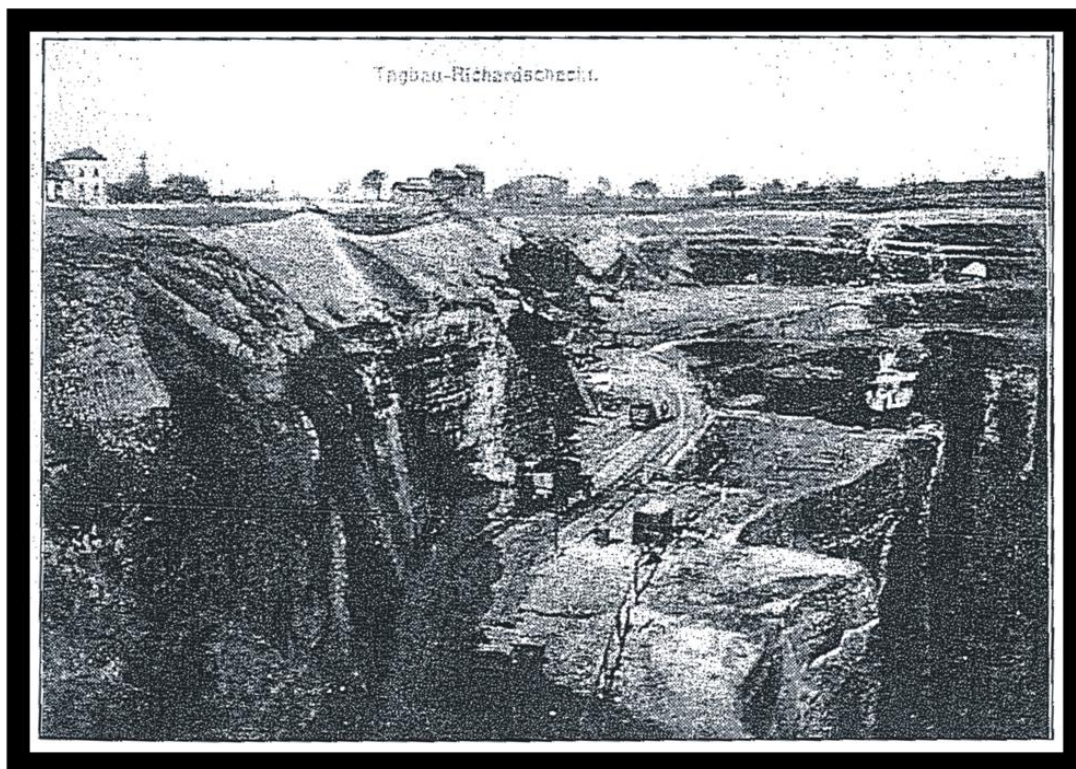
Spouštění pilířů, (Kloš 2009)
